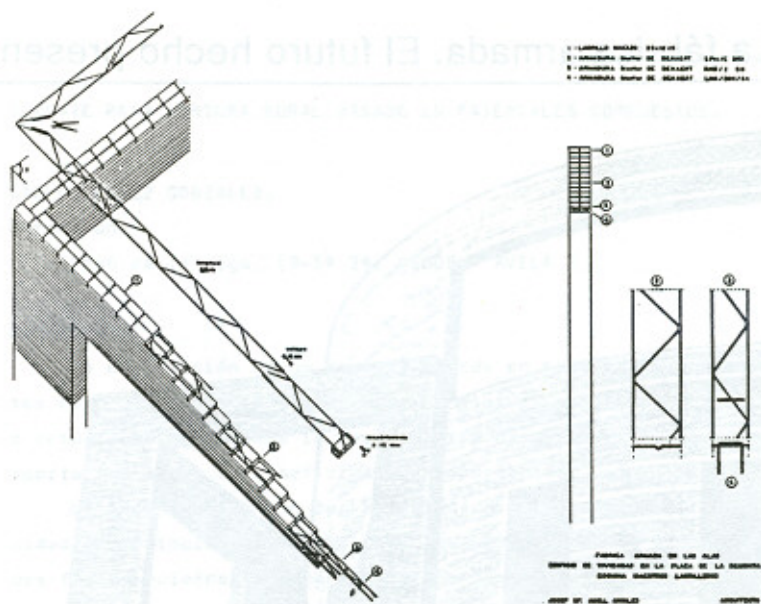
Detalle de las alas del edificio de viviendas de la Plaza de La Remonta con fábrica armada.
